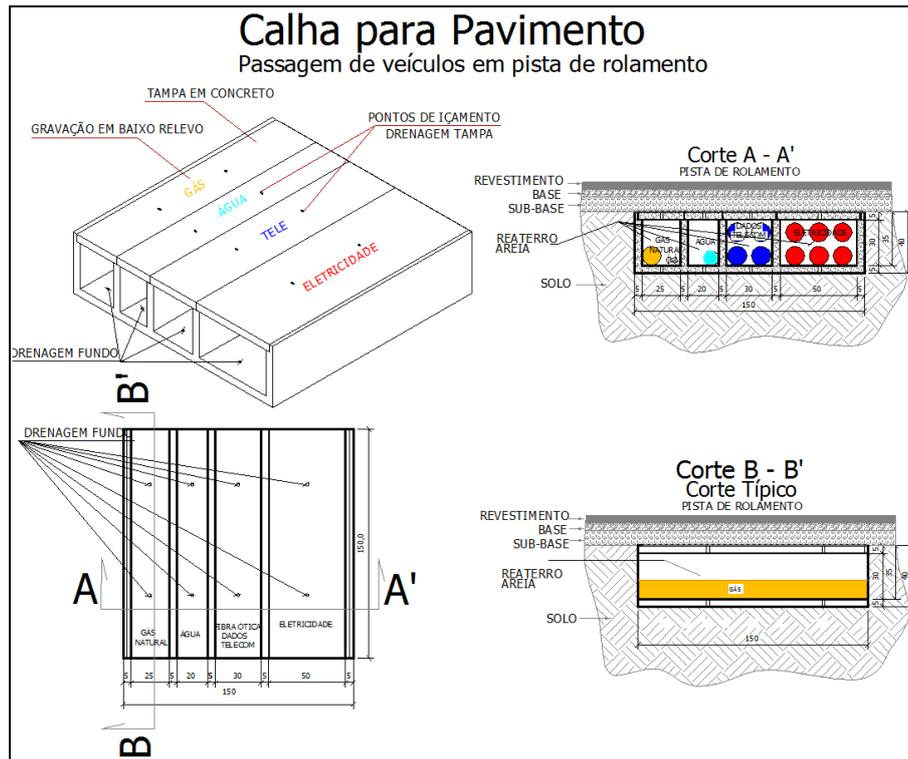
Detalhe de calha de pavimento – cruzamento de pavimento de alto tráfego.
